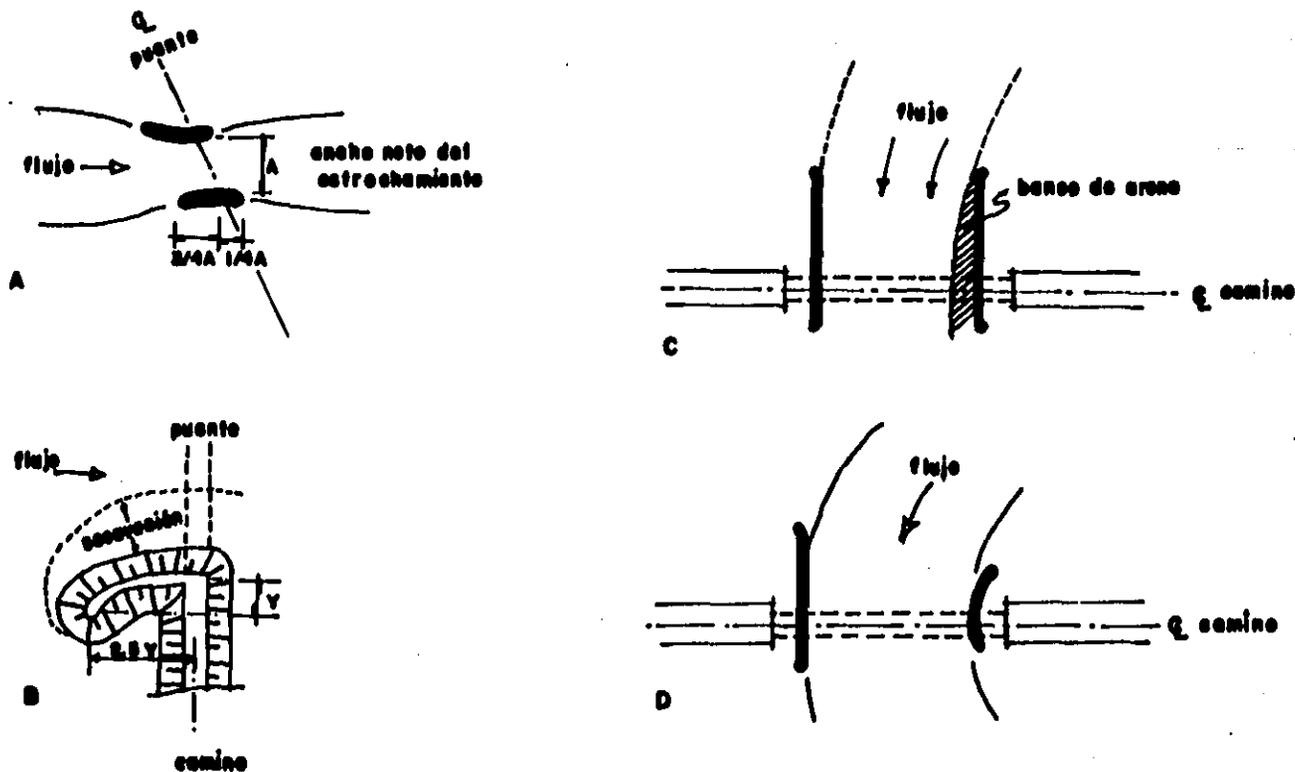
Longitud y distribución en planta de muros de encauce.
